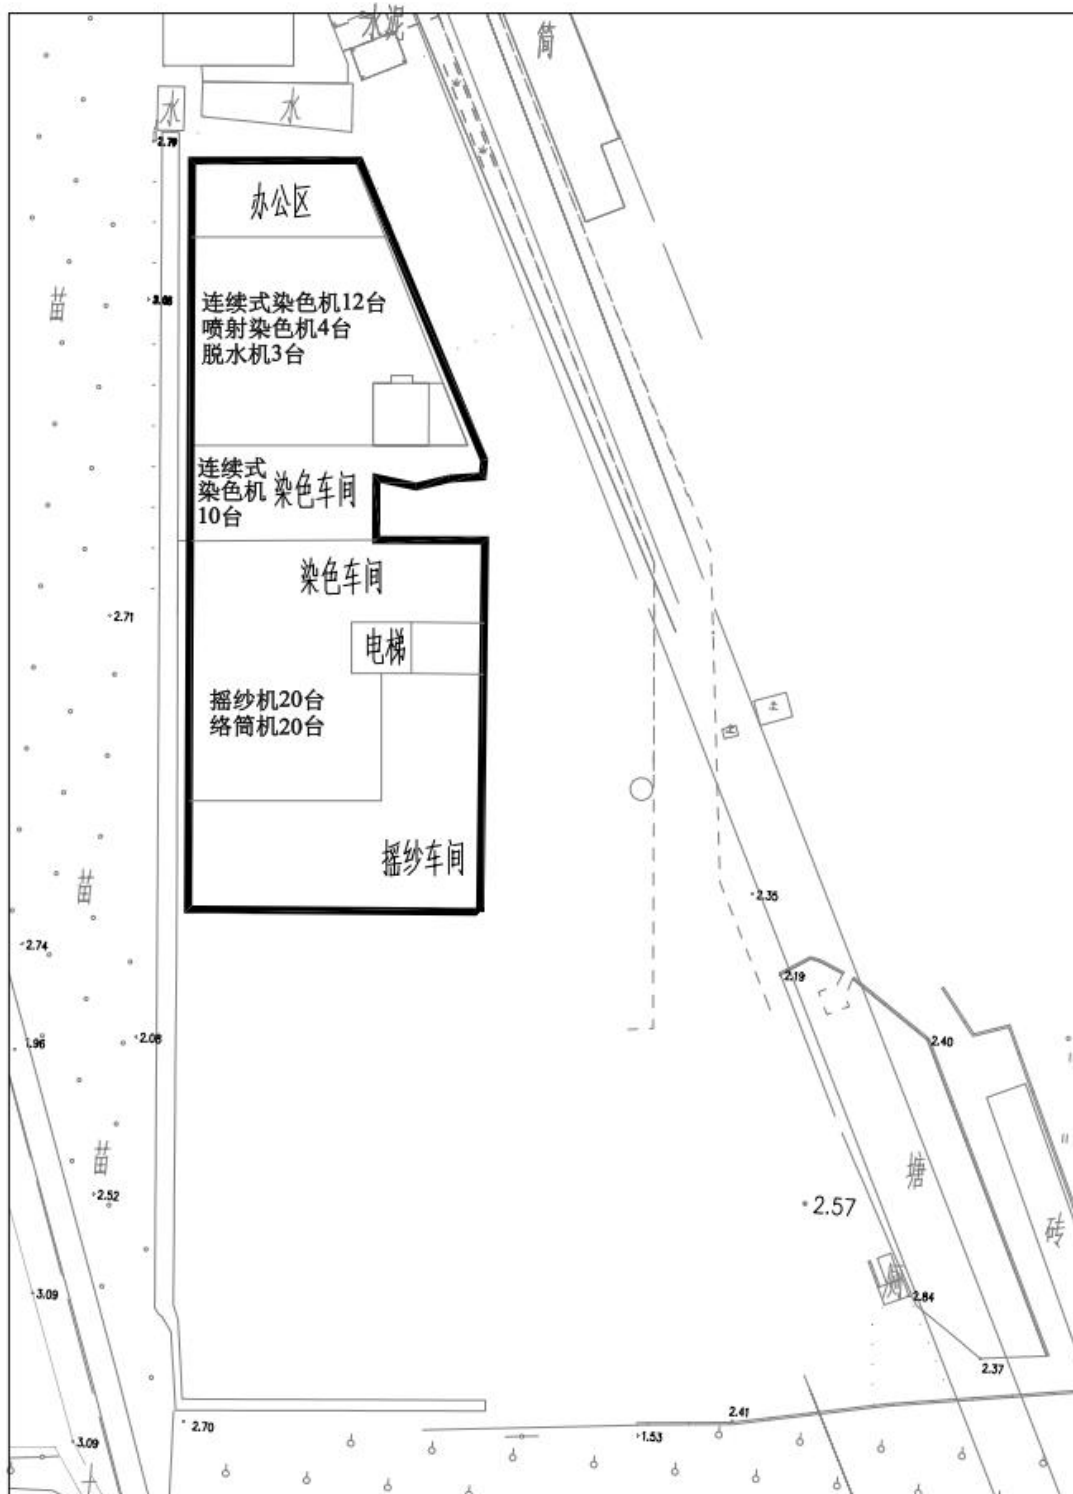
项目四层平面布置图（比例尺 1: 600）
